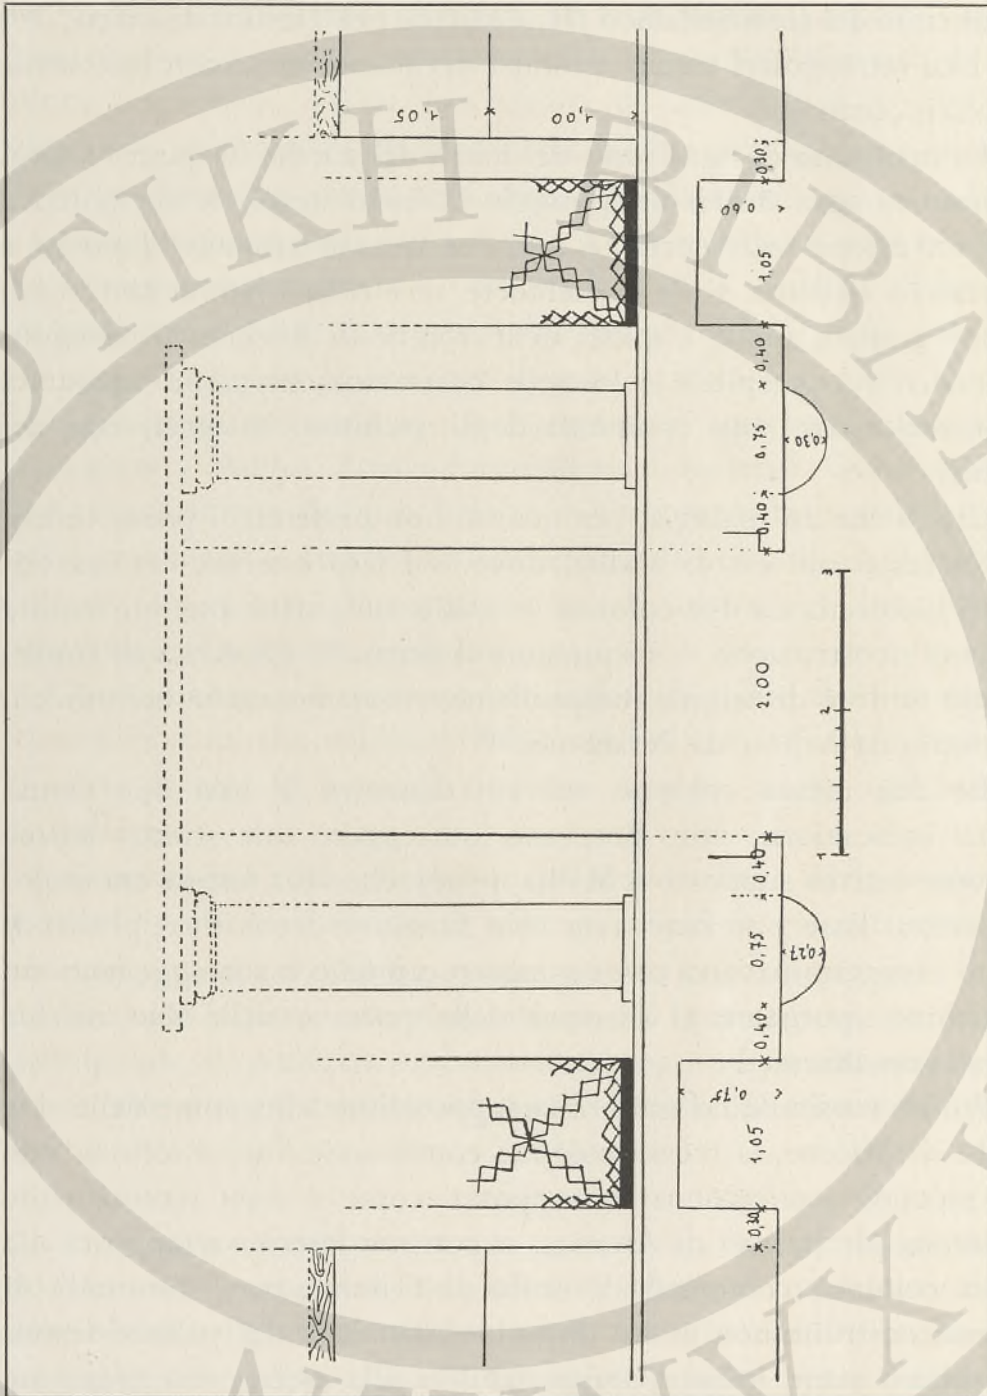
RICOSTRUZIONE DELL'ALZATO E SEZIONE DELLA PORTA DI INGRESSO AL CORRIDOIO 41
